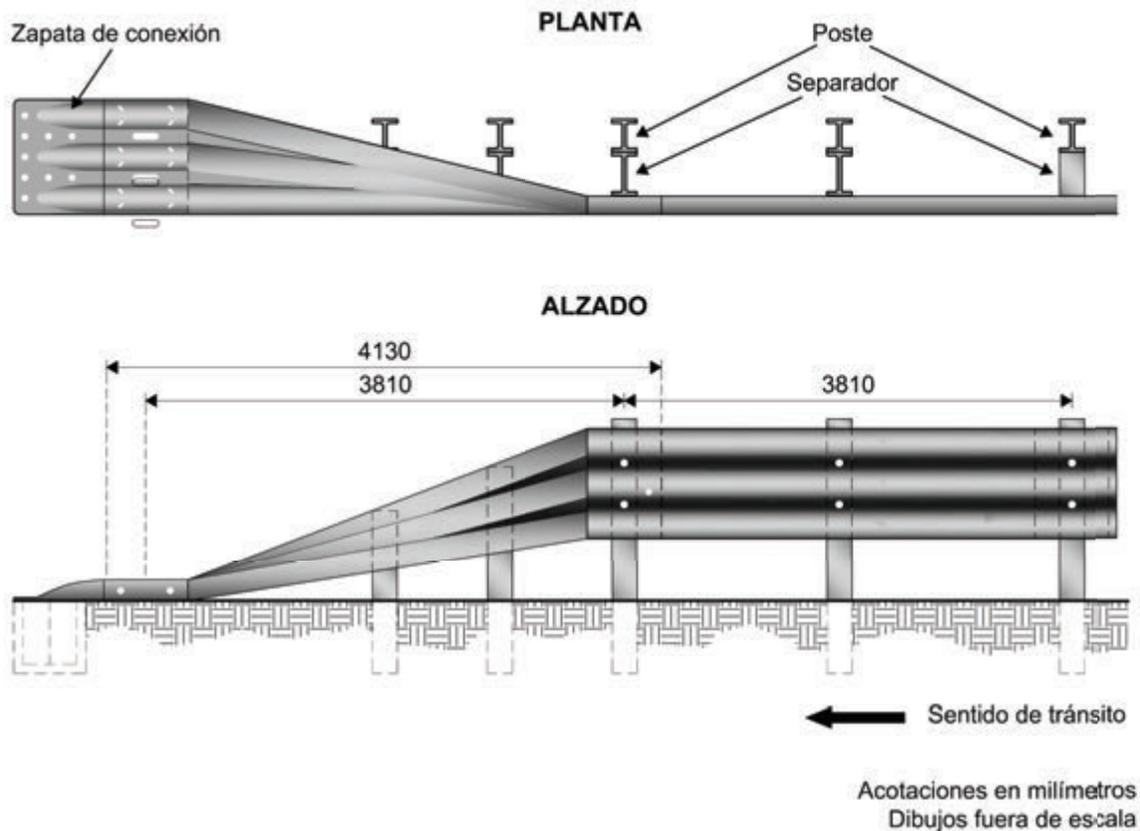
Sección terminal Aterrizada para vigas acanaladas de dos y tres crestas (OD-4.4.2/A)
